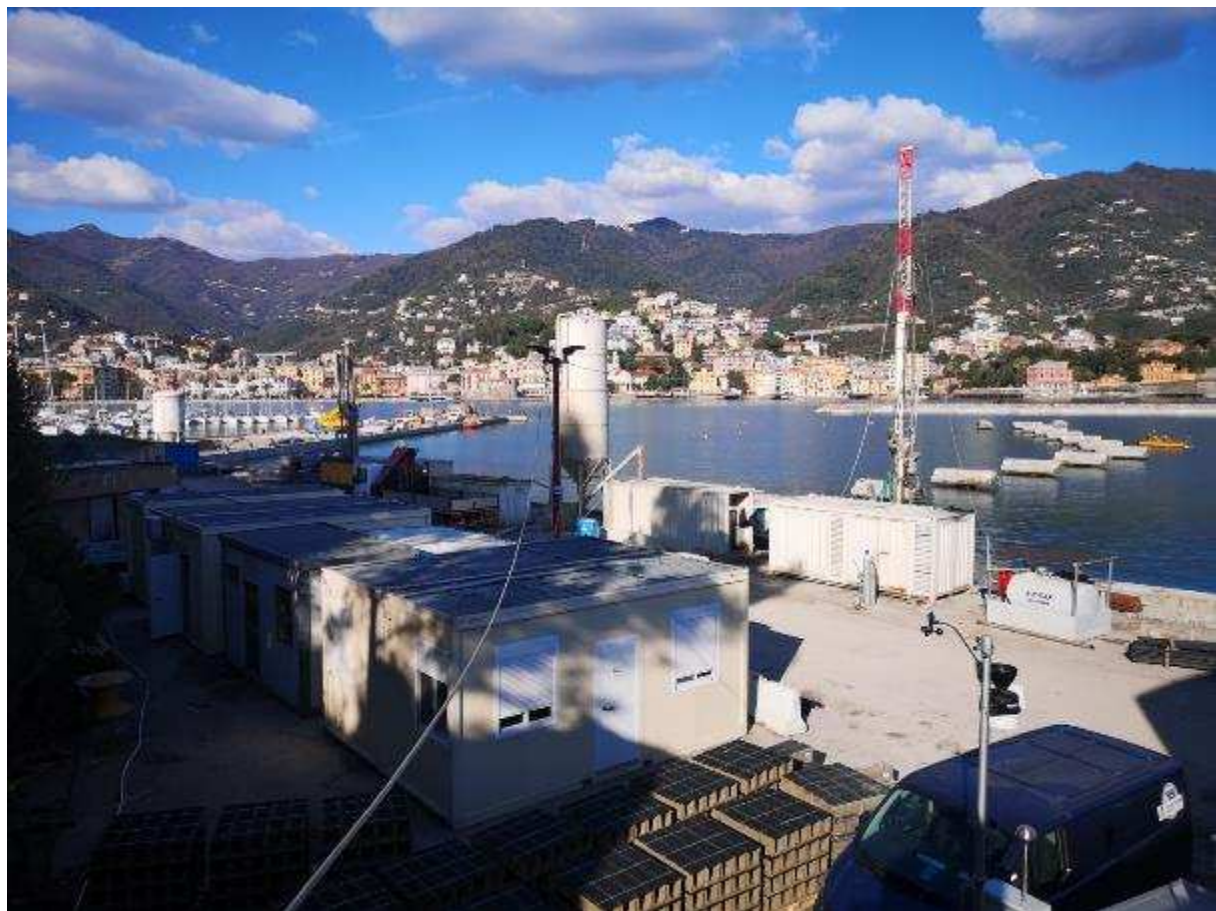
03.03.2023 – il cantiere per l'esecuzione del consolidamento con jet-grouting
